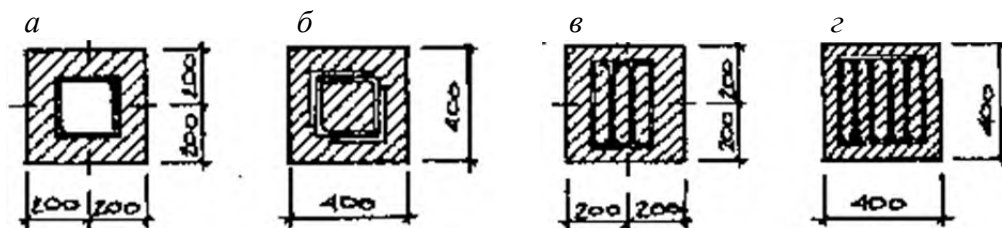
Варианты стыков сборных железобетонных колонн с жесткой арматурой:
